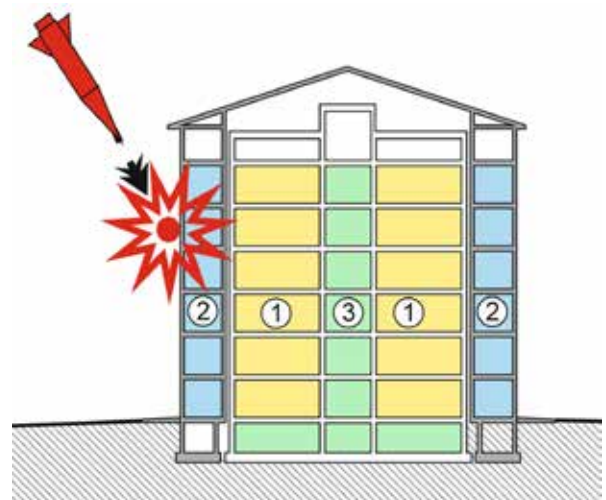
Схема руйнування п'яти прогонувої будівлі лікарні: 1 – кабінети, палати; 2 – коридор; 3 – укриття
